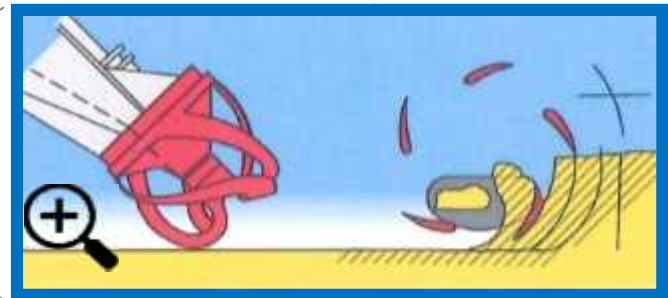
Zoom sur la tête rotative du désagrégateur - Technique de coupe
